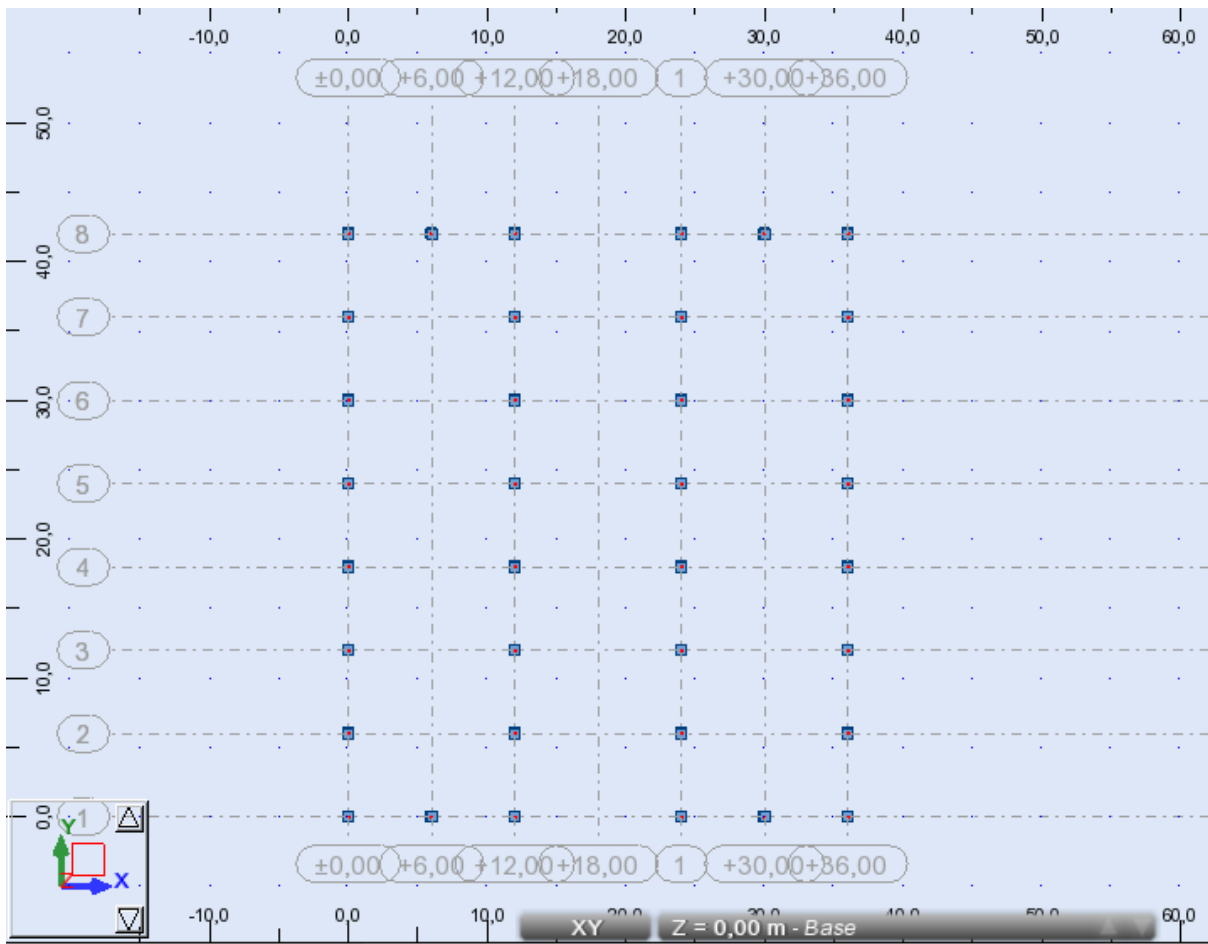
Vue en plan de l'ouvrage Z=0m
